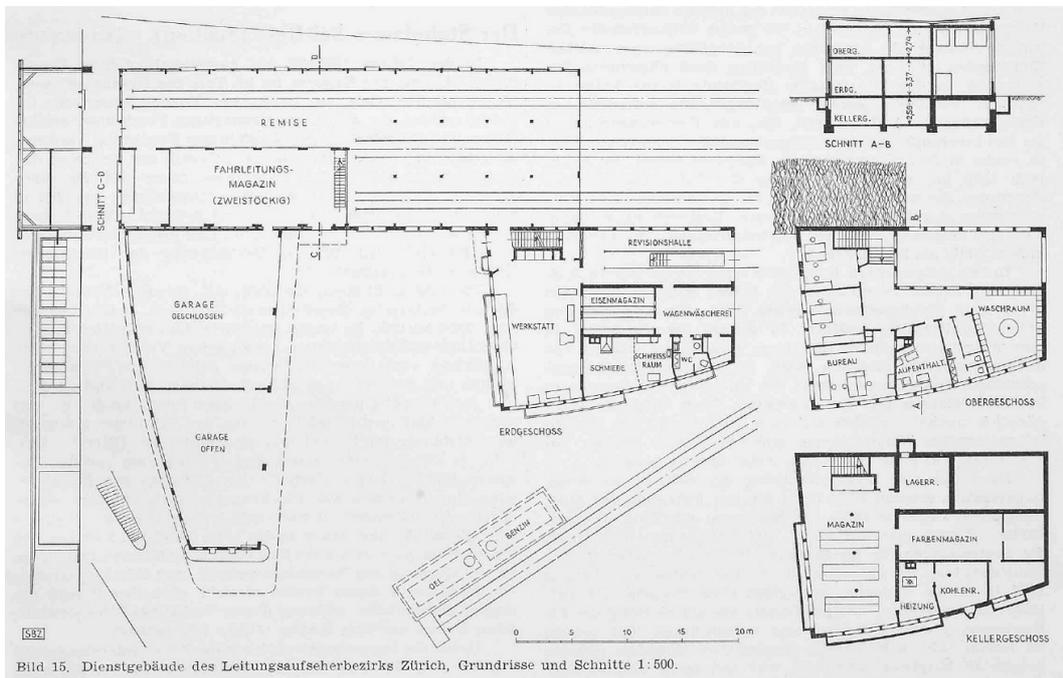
Dienstgebäude des Leitungsaufseherbezirks Zürich, Grundrisse und Schnitte 1:500.
